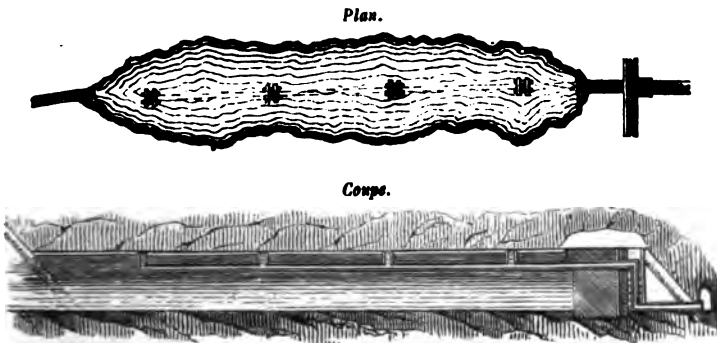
Disposition d'un lac dans les salines d'Hallein.
